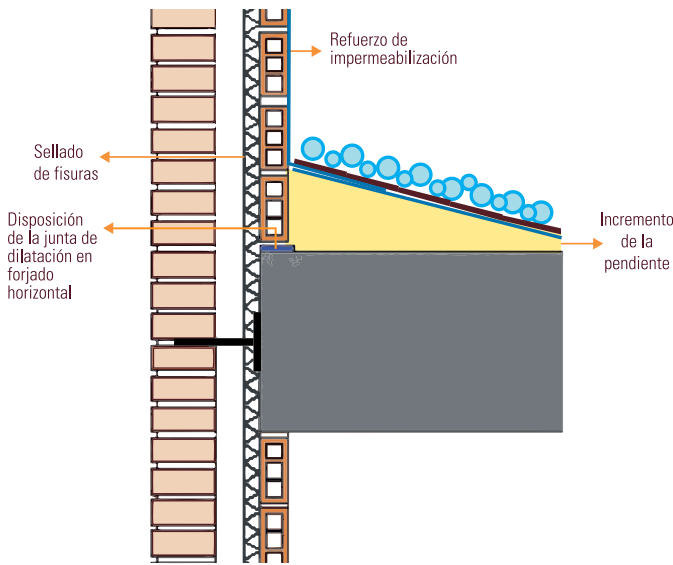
Disposición de junta de dilatación perimetral, incremento de la formación de pendiente y sellado de fisuras
